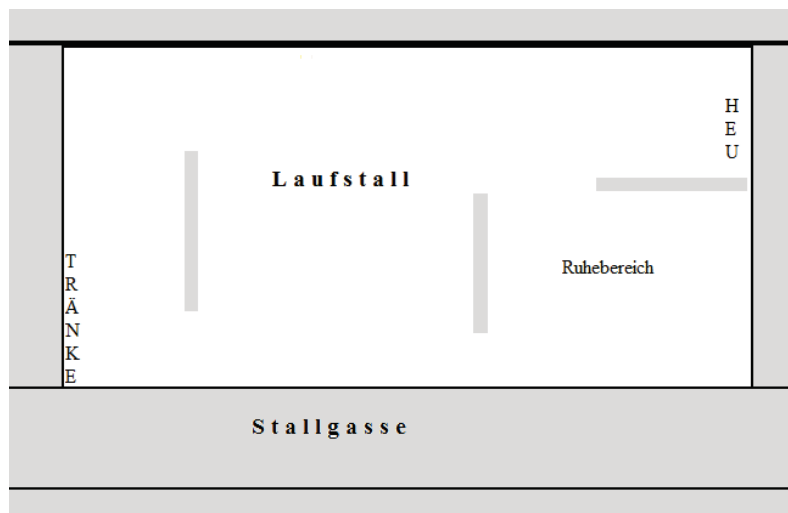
Grundriss eines Mehrraum-Gruppenlaufstalls
